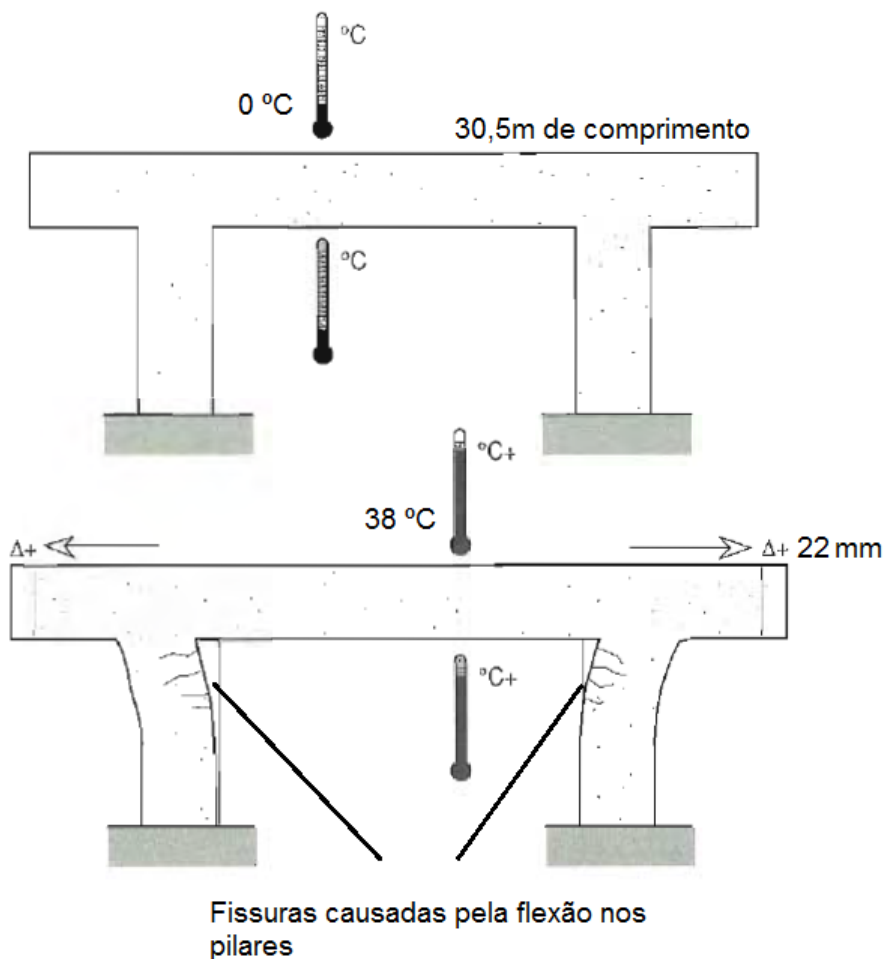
Efeitos da expansão térmica em estruturas de concreto com movimentação restrita. (Fonte: Emmons, 1994 – adaptado).
